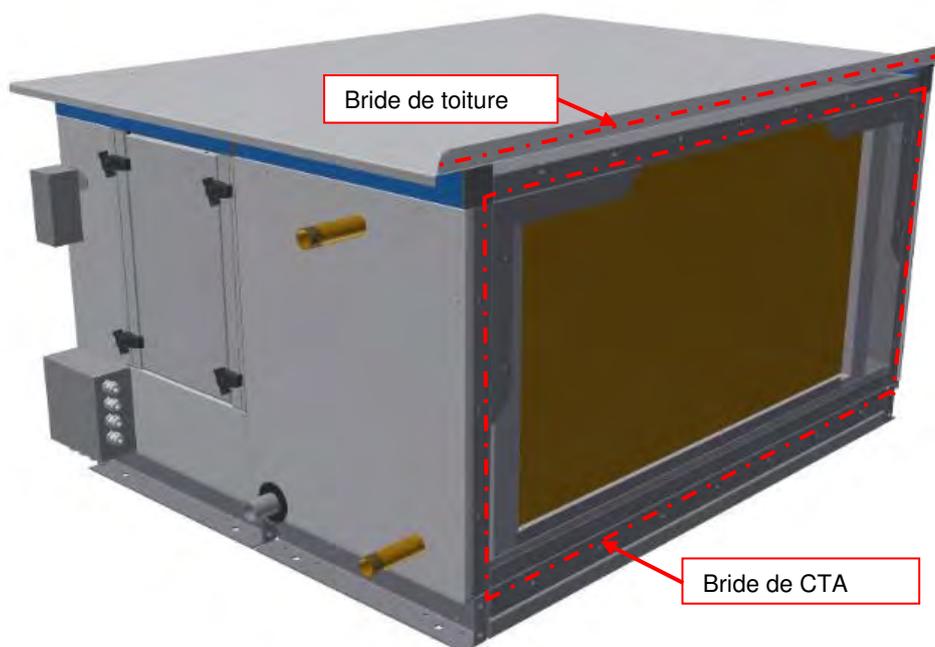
Application du matériau d'étanchéité sur les raccords frontaux
